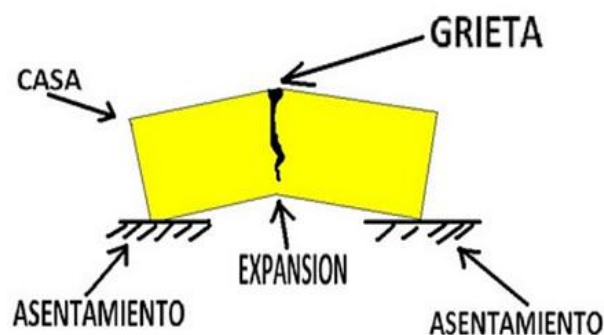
Falla por flexión de un muro (Fuente: Internet)
